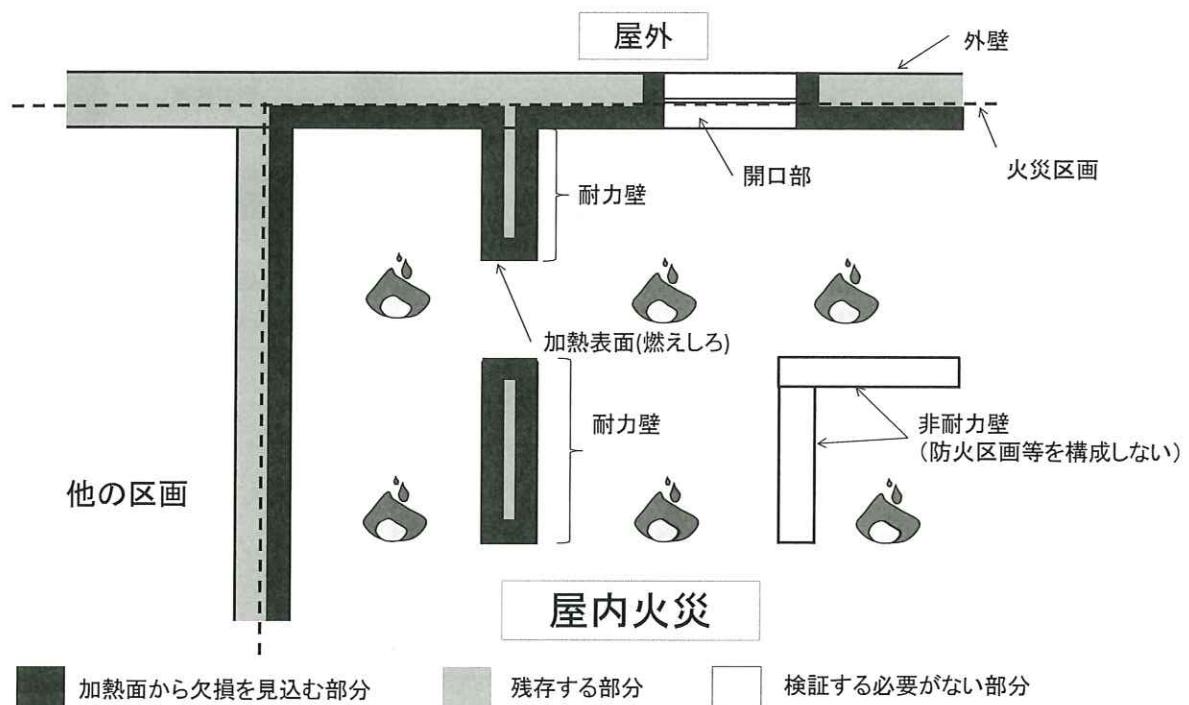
屋内火災における防火区画内の燃えしろ想定面（平面図）
